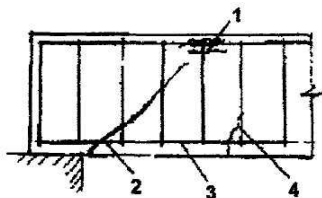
Схема разрушения железобетонного элемента по наклонному сечению из-за продергивания арматуры на свободной опоре:
